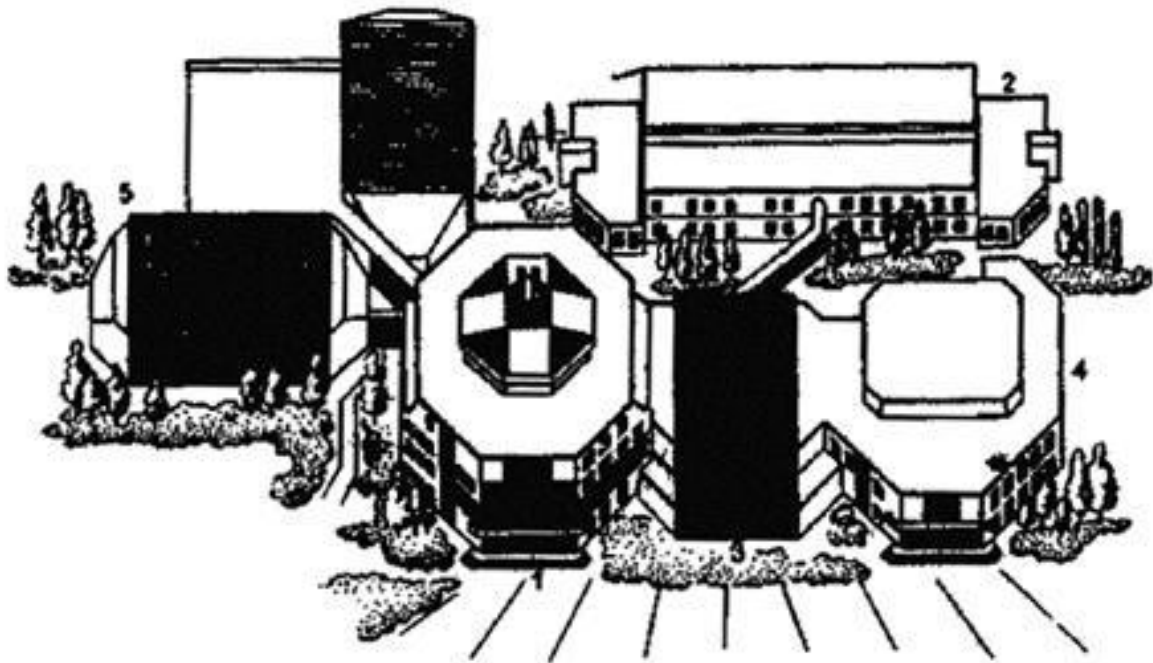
Коледж з виділеними клубно-спортивними корпусами для населення.
